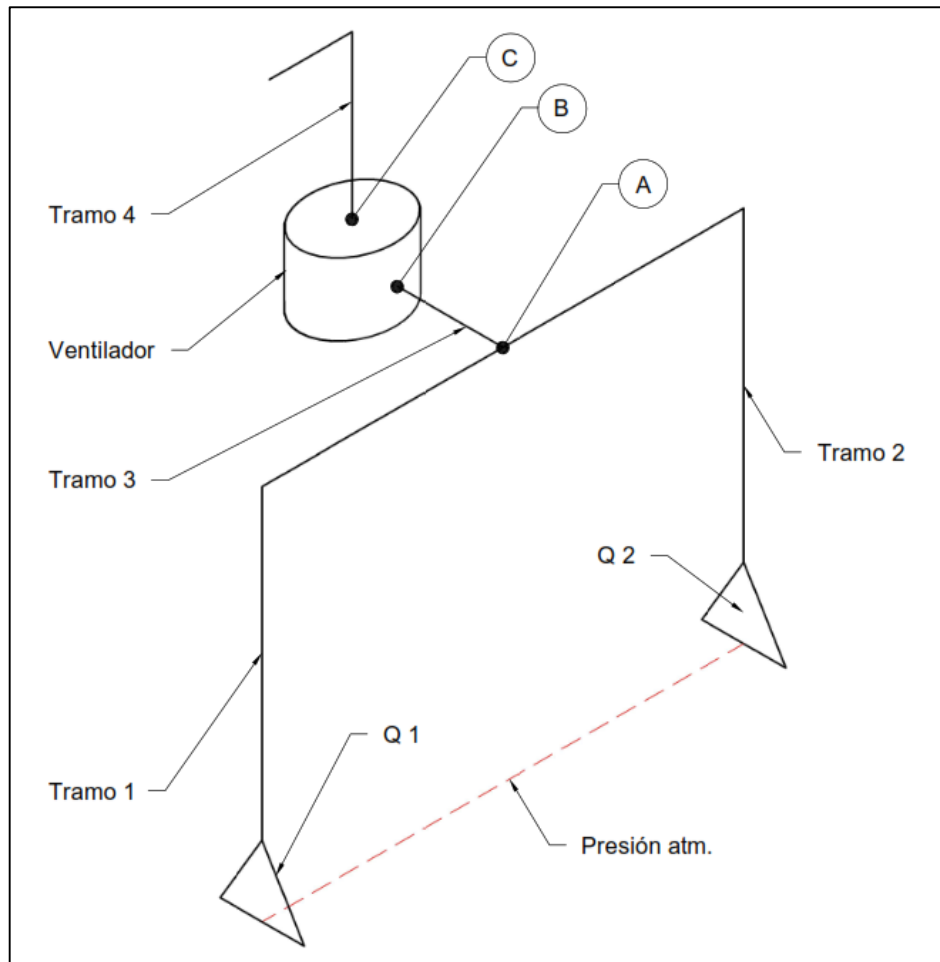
Zona de Lavado de la planta Komatsu - III
